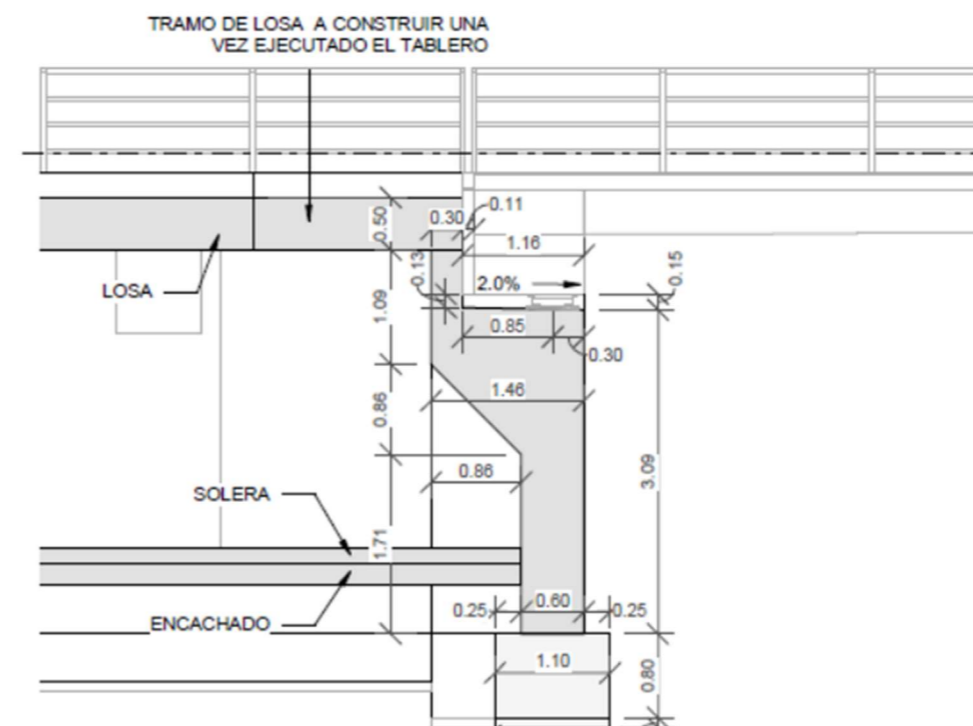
Perfil del estribo 1. (Fuente: Documentación aportada)
